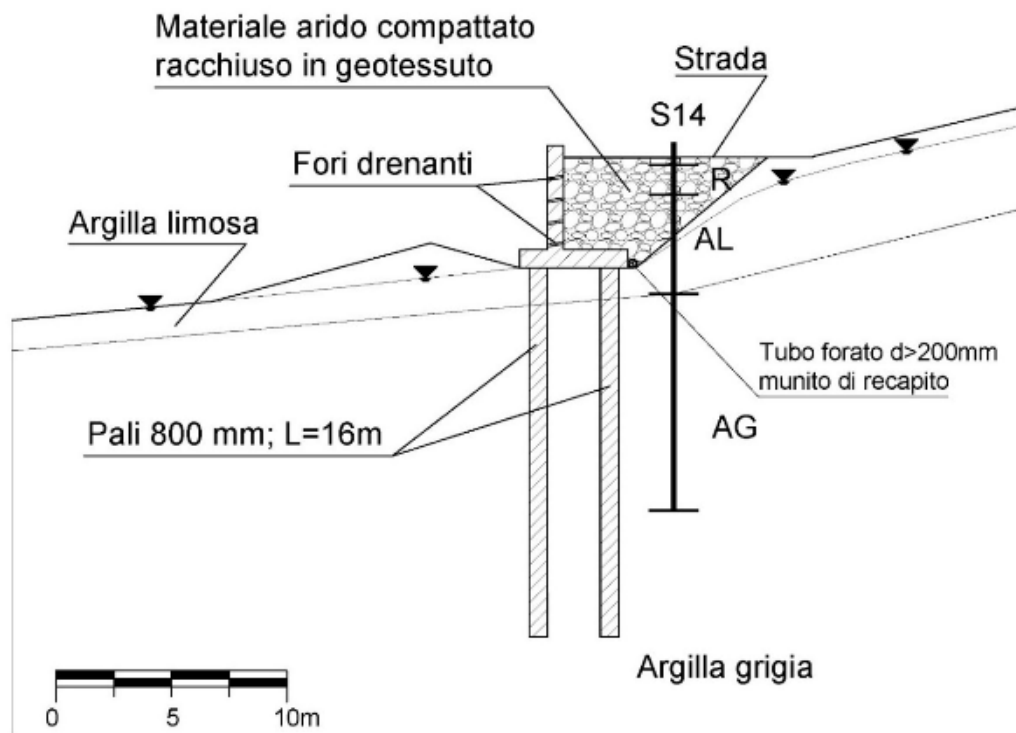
Zona Pietralunga, km 8+700. Sezione schematica A-A'.
